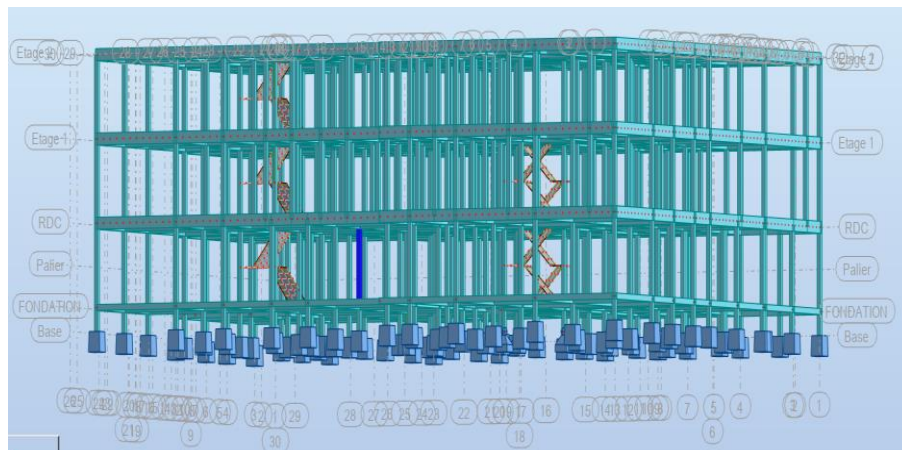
Poteau le plus chargé de la RDC en élévation
